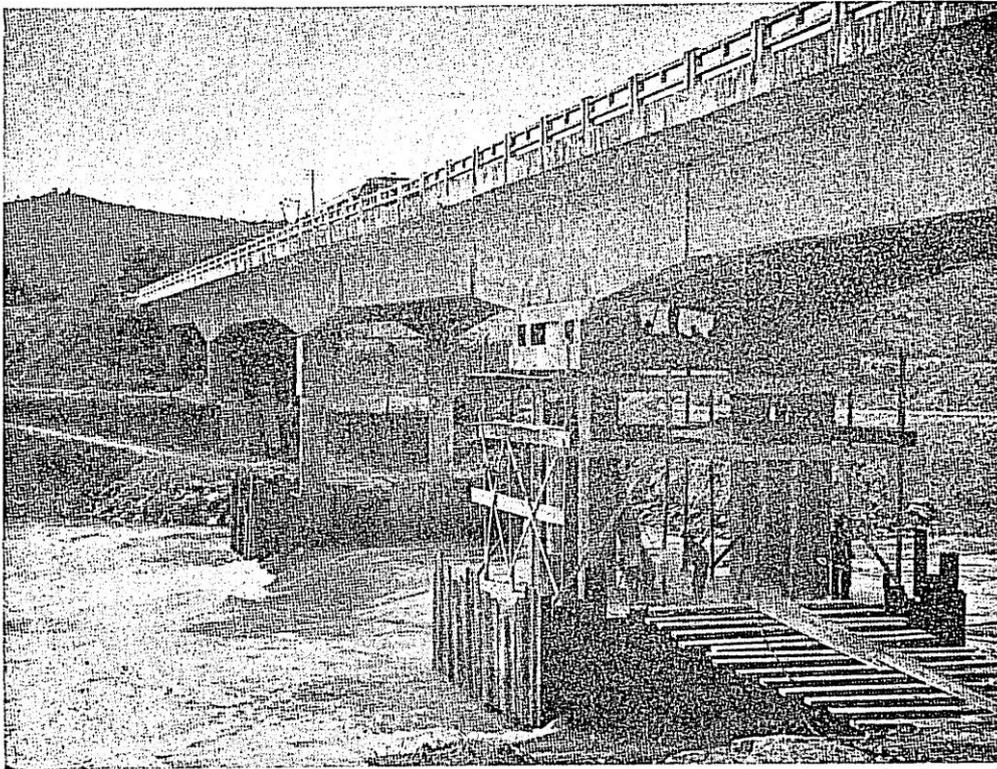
Aspecto geral dos pilares 5-6 e 7-8, com as ensecadeiras já construídas.
